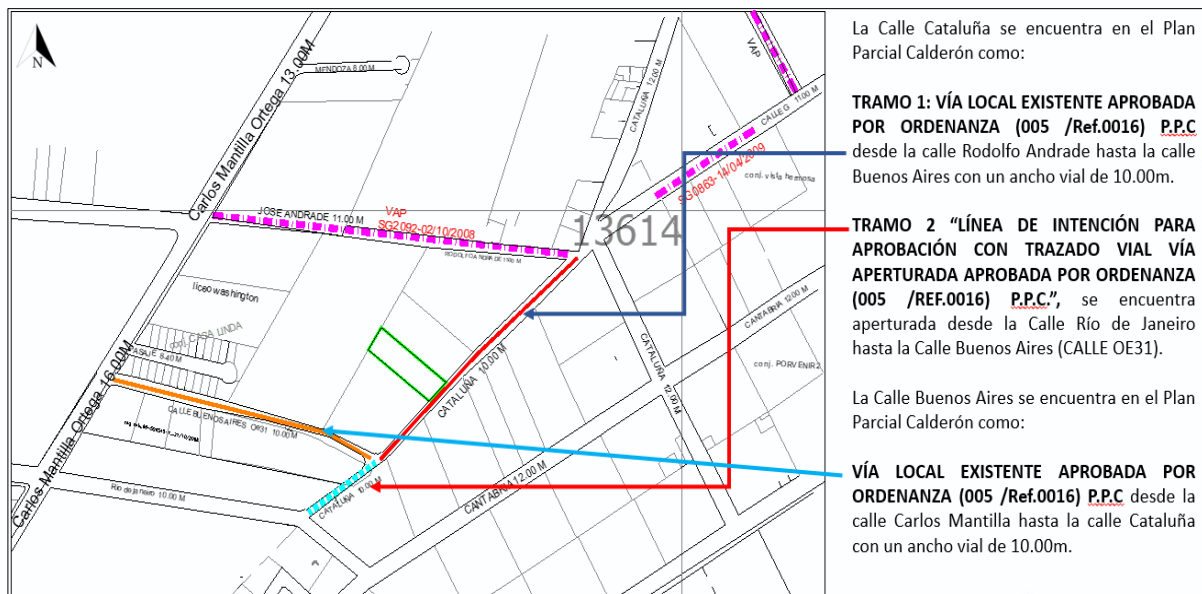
Plano vías a ser regularizadas. Fuente: Plan Parcial Calderón.
